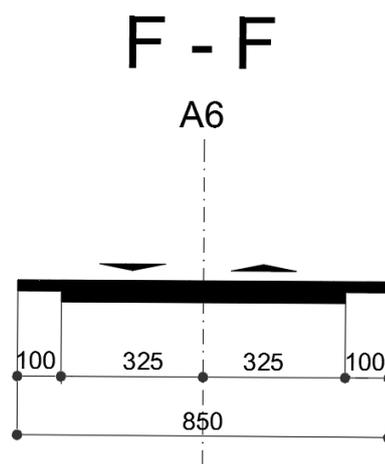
Esempio sezione stradale utilizzata per la strada d'ingresso al terminal gateway, misure in cm
